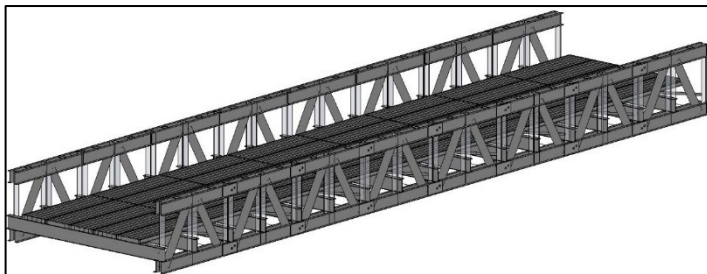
Puente modular en su configuración de 28,20 m, sin pasillo.
